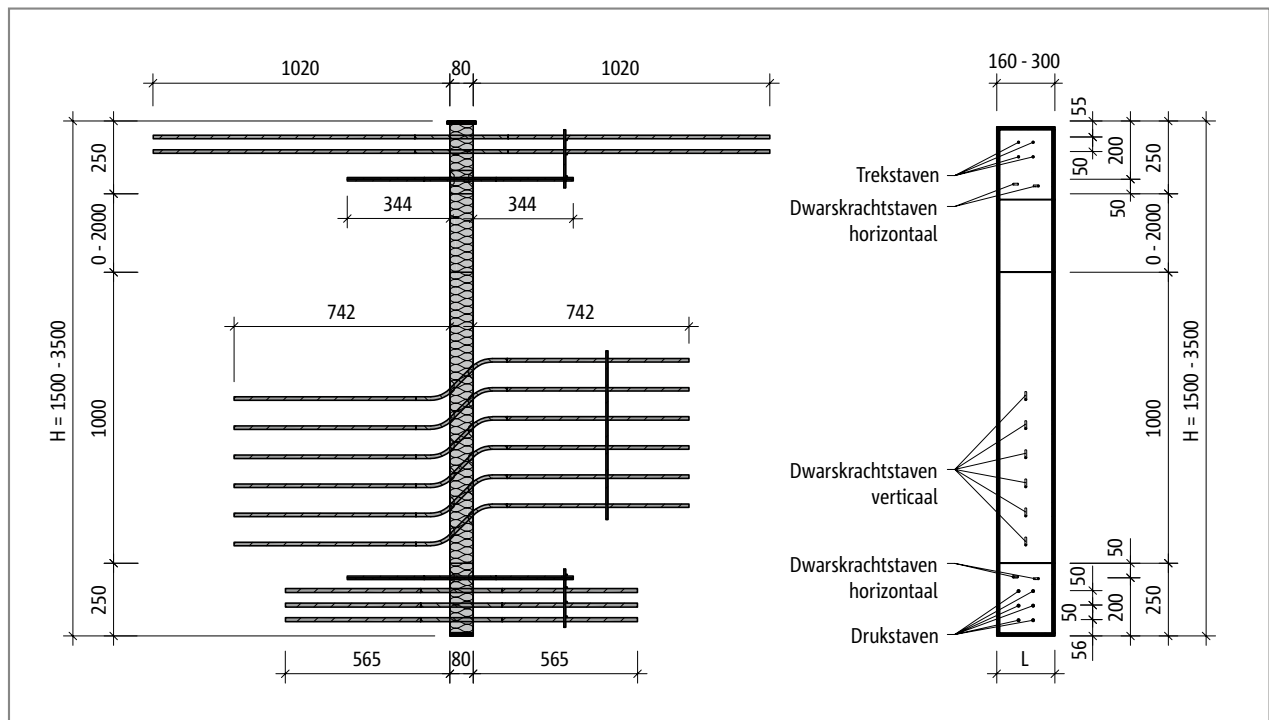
Schöck Isokorb® T type W-M1: Bovenaanzicht
